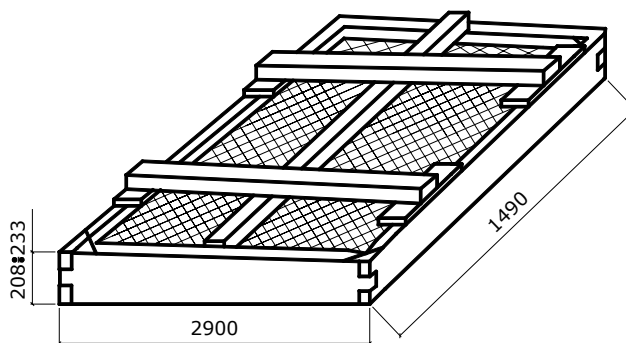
Плита на дерев'яному каркасі з обшивкою з азбестоцементних листів для улаштування на прогонах
